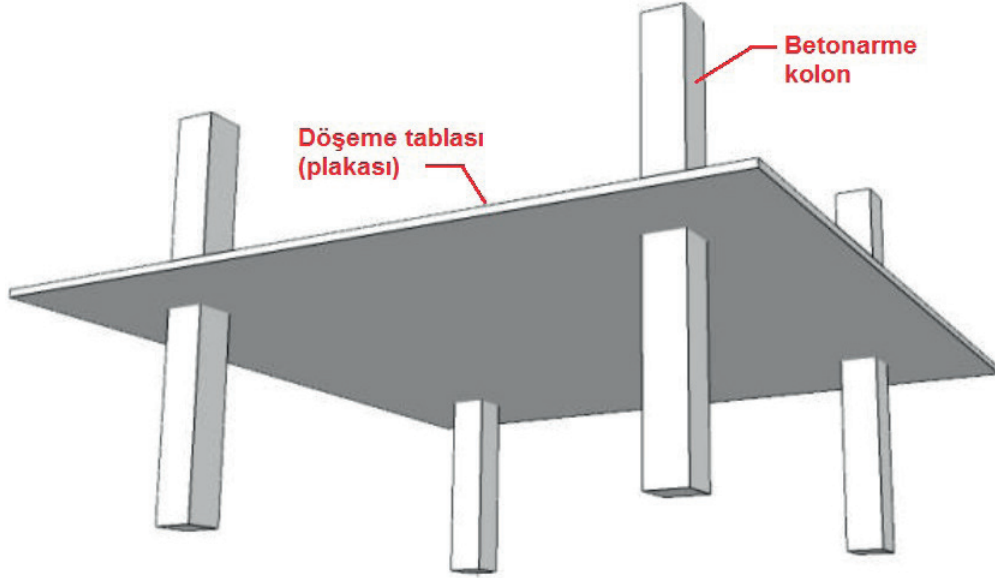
Betonarme sürekli plak döşeme perspektif krokisi
